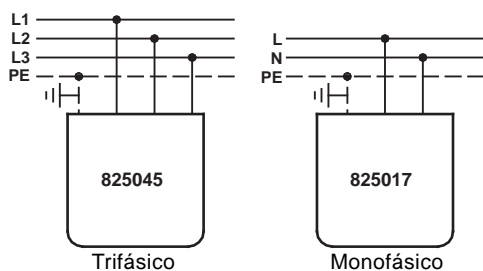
Montaje de un dispositivo de protección contra sobrevoltaje
